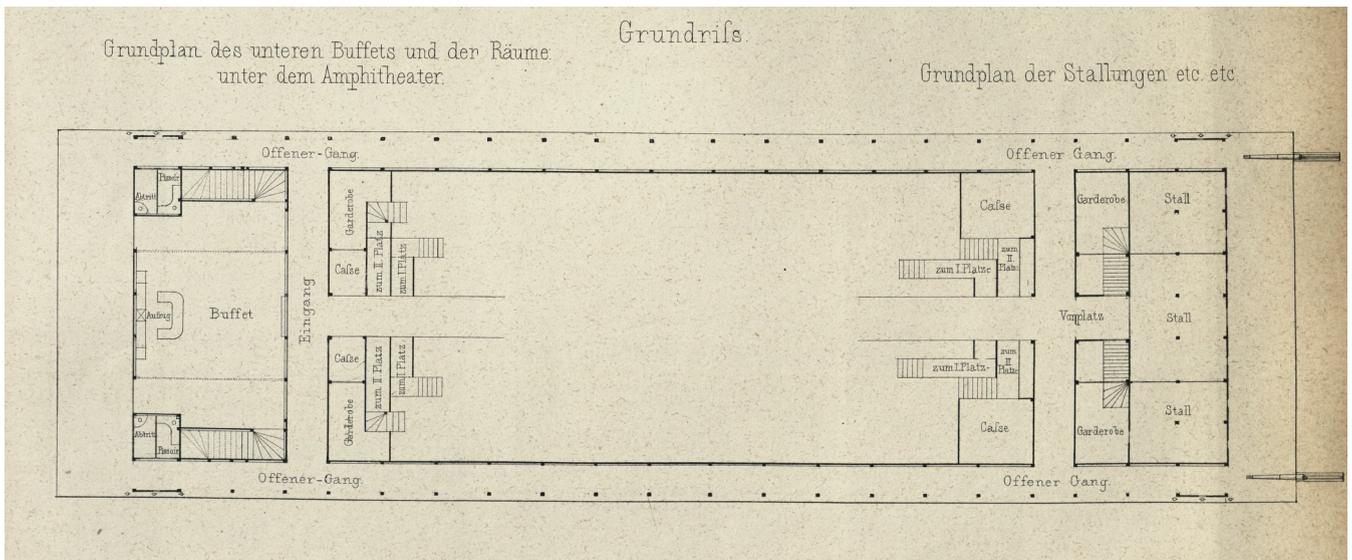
Grundriss bzw. Grundplan der unteren Räume und Stallungen.
